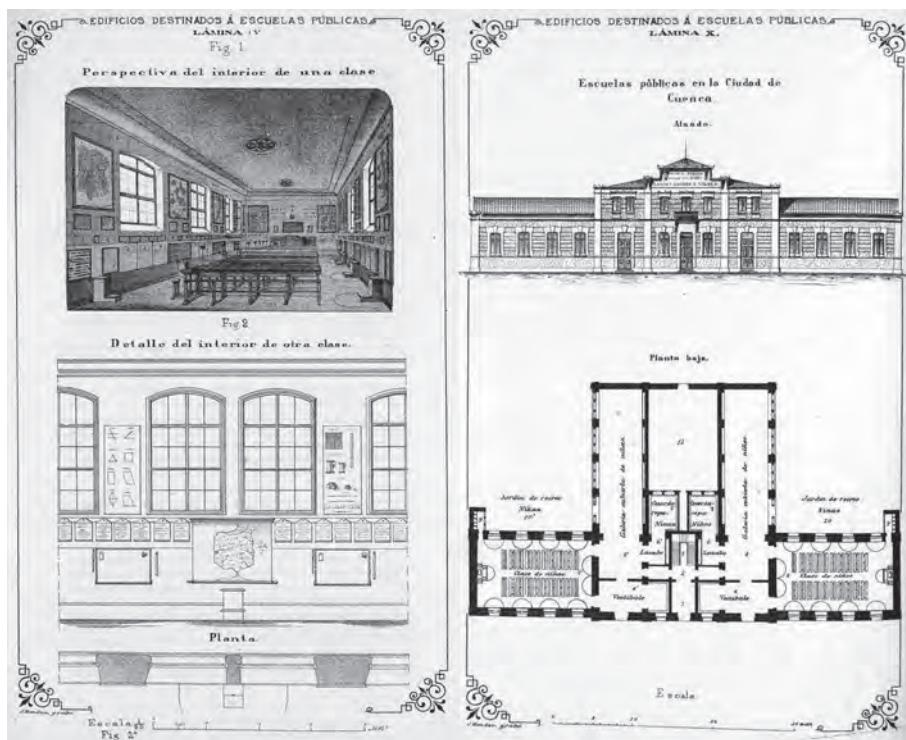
Interior de un aula (izquierda) y planimetría de una escuela para Cuenca (derecha) publicadas en el libro *Disposición, Construcción y Mueblaje de las Escuelas Públicas de Instrucción Primaria* (Fuente: Repullés, 1878: láminas IV y X).
